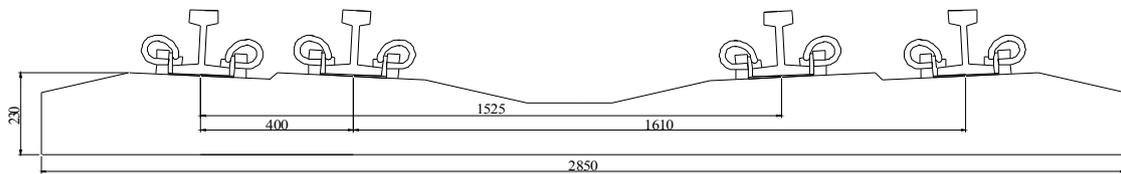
железобетонная шпала под совмещенный путь.
